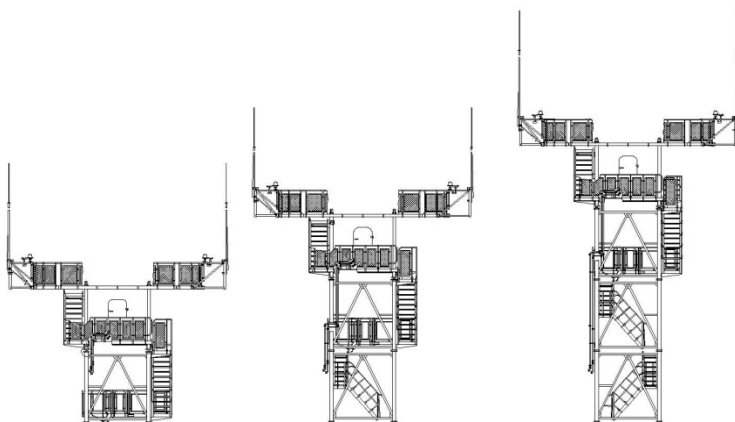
Схема компоновки башни локатора с применением крупногабаритных корпусов модульной системы типовых несущих конструкций
